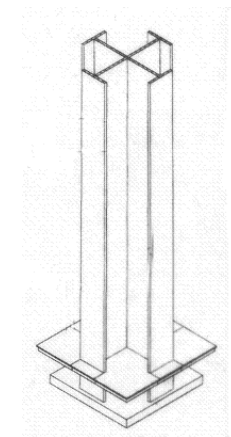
Pilar Neuegalerie Berlin, 1968.
